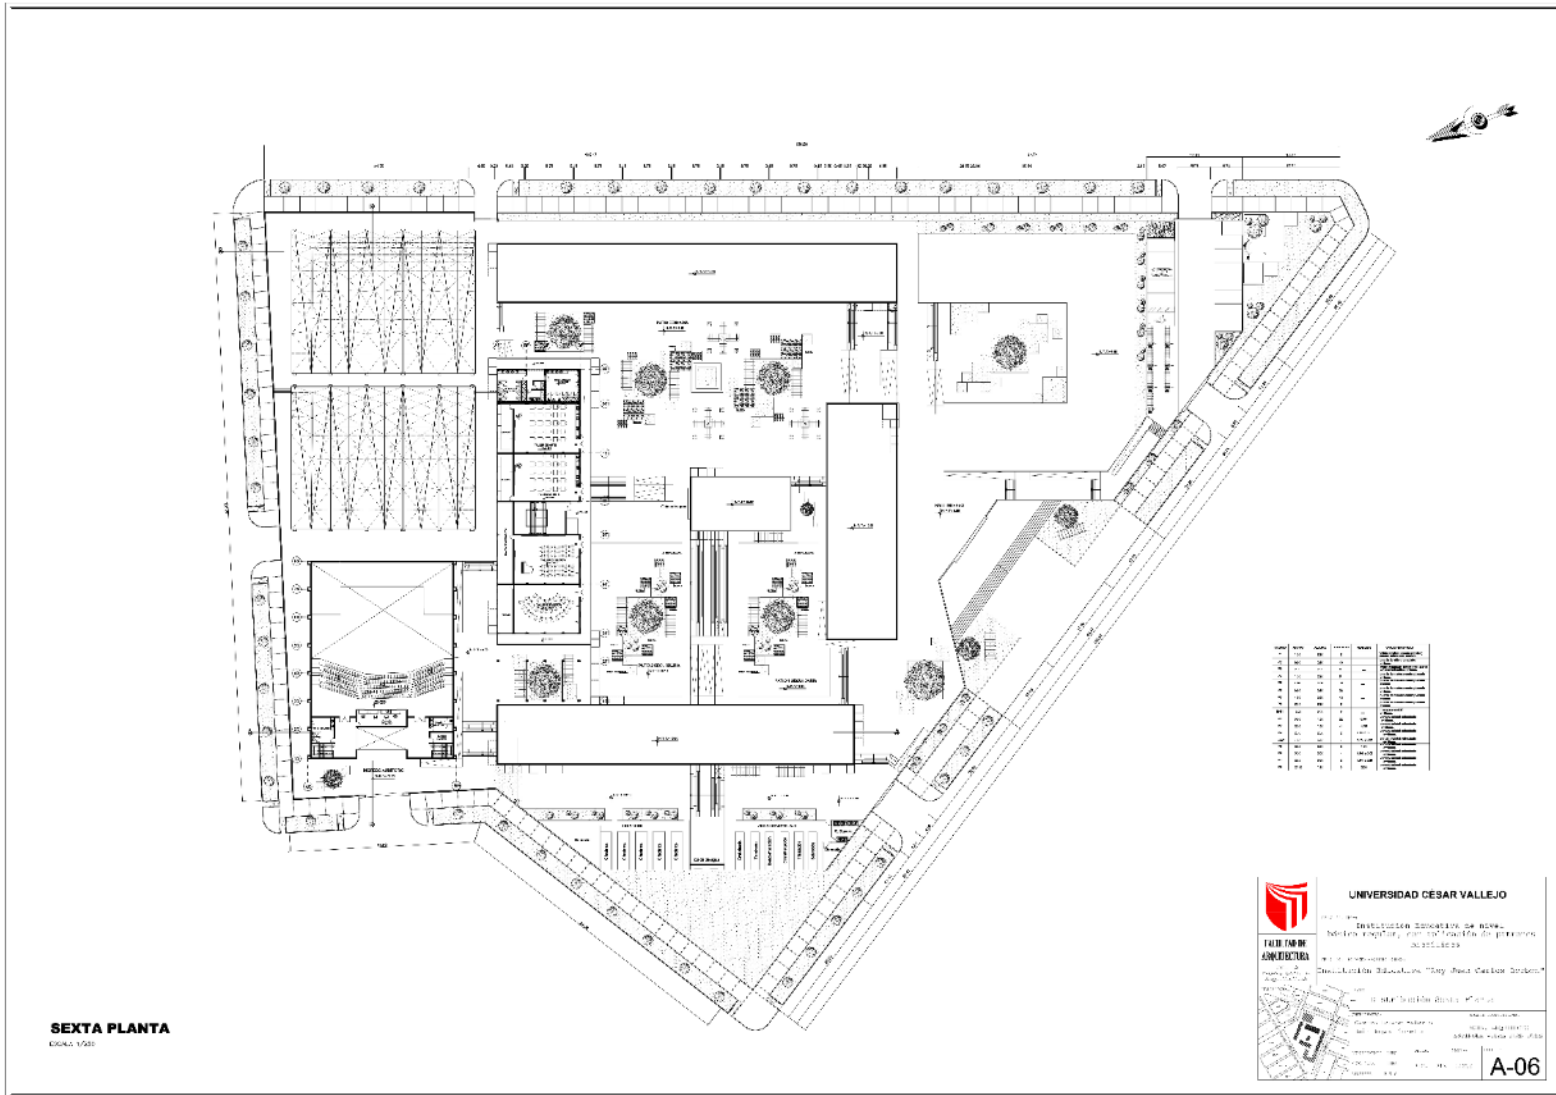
Plano sexta planta*, Fuente: elaboración propia
